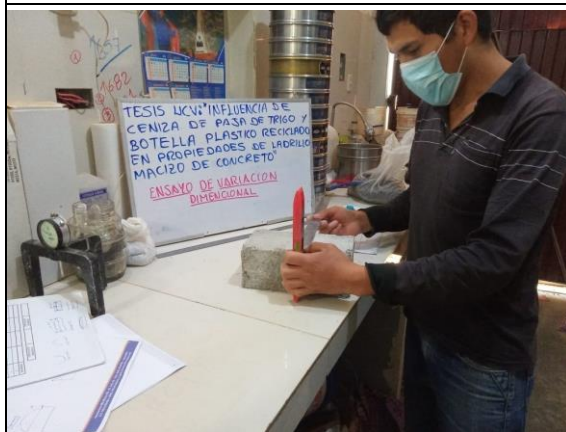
Ensayo de variación dimensional de ladrillos macizo de concreto.
